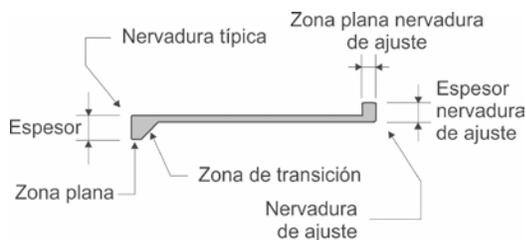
Sección transversal del PV tipo ajuste Zona plana nervadura
